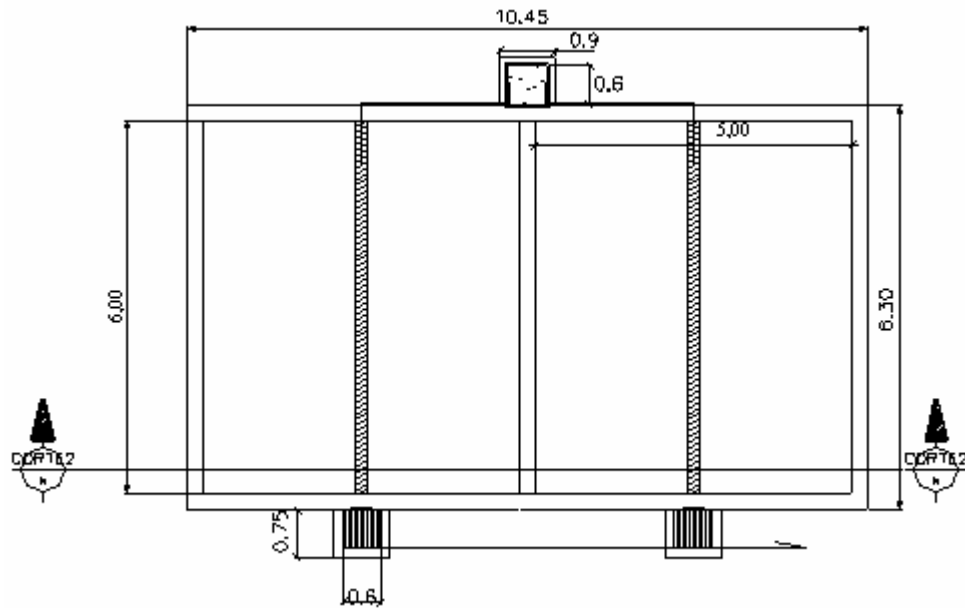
Planta dos módulos do Leito de Drenagem
